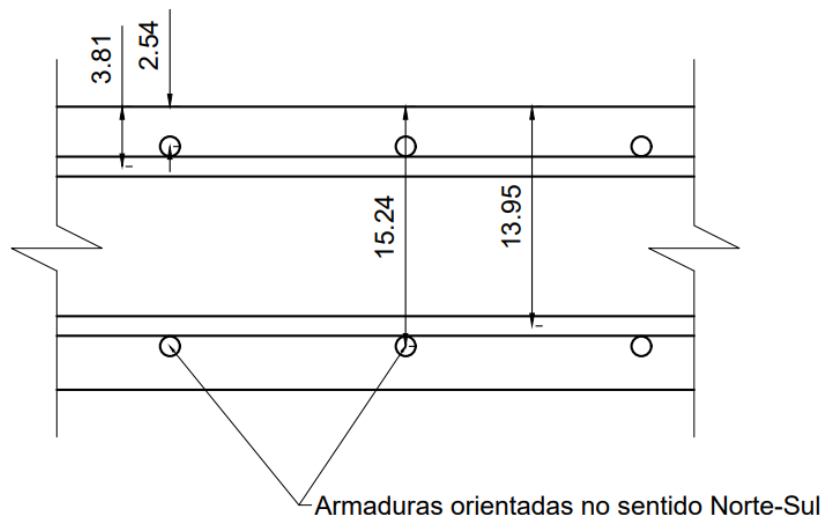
Detalhe das armaduras longitudinais e transversais das lajes. Adaptado de Fick (2008).
